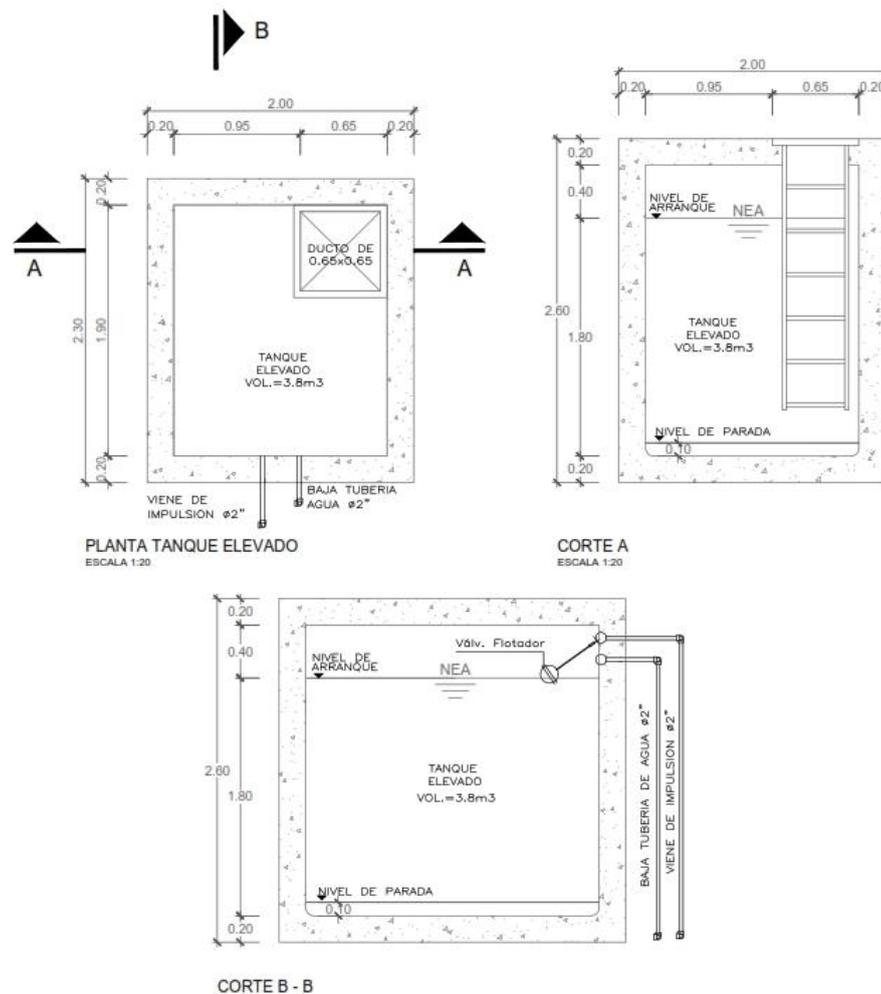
Cálculos de Diseño de tanque elevado. Fuente: elaboración propia.
